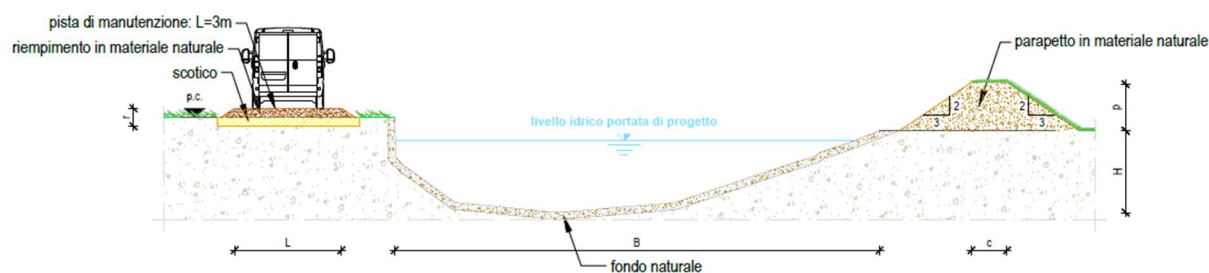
Sezione tipologica di progetto del tratto CIR-03-03 – completezza dell'intervento.
